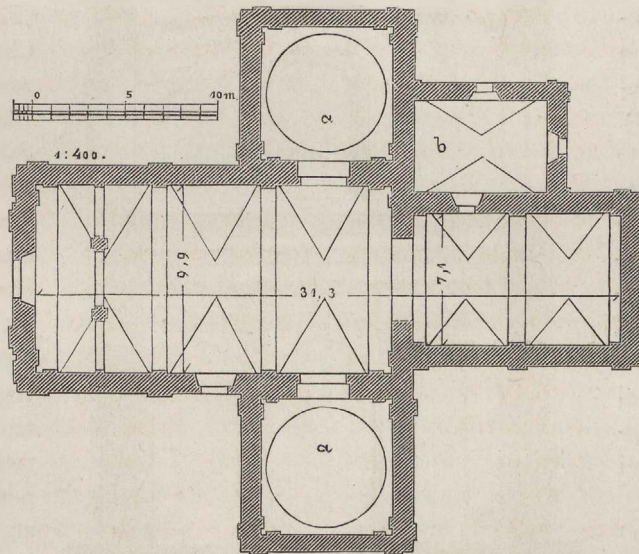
Flatow. Grundriss der kathol. Kirche.
